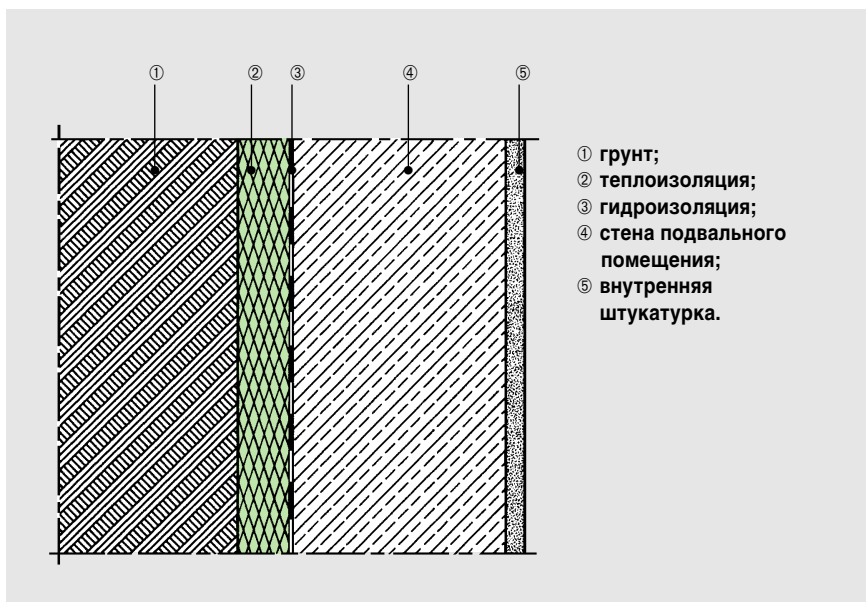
Стена подвального помещения с внешне расположенным теплоизоляционным слоем, граничащим с грунтом.
